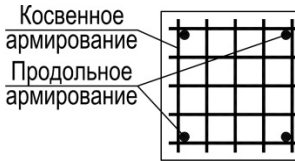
Схема поперечного сечения колонны с косвенным армированием
